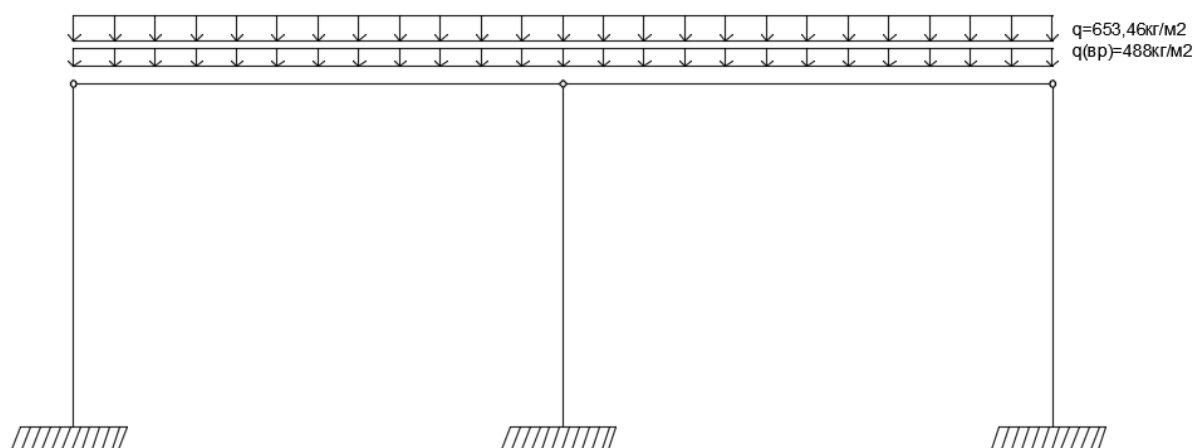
Схема распределения нагрузок на плите перекрытия
